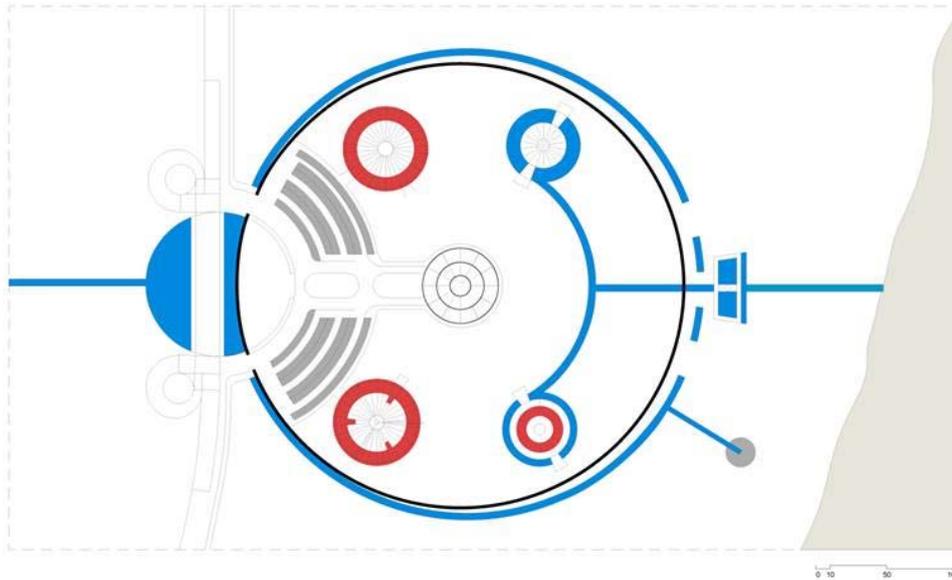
Planta esquemática base da primeira versão do Hotel Tropical de Manaus.
